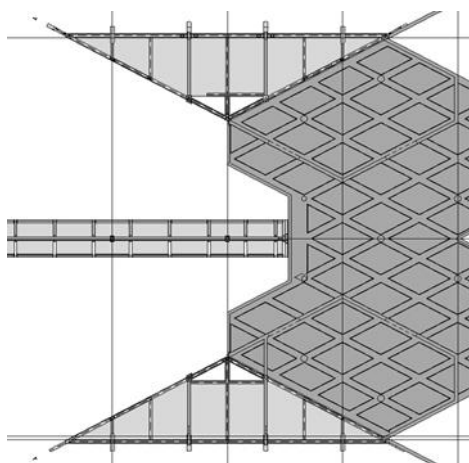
Impalcato LC1, modulo Sud: vista in pianta
